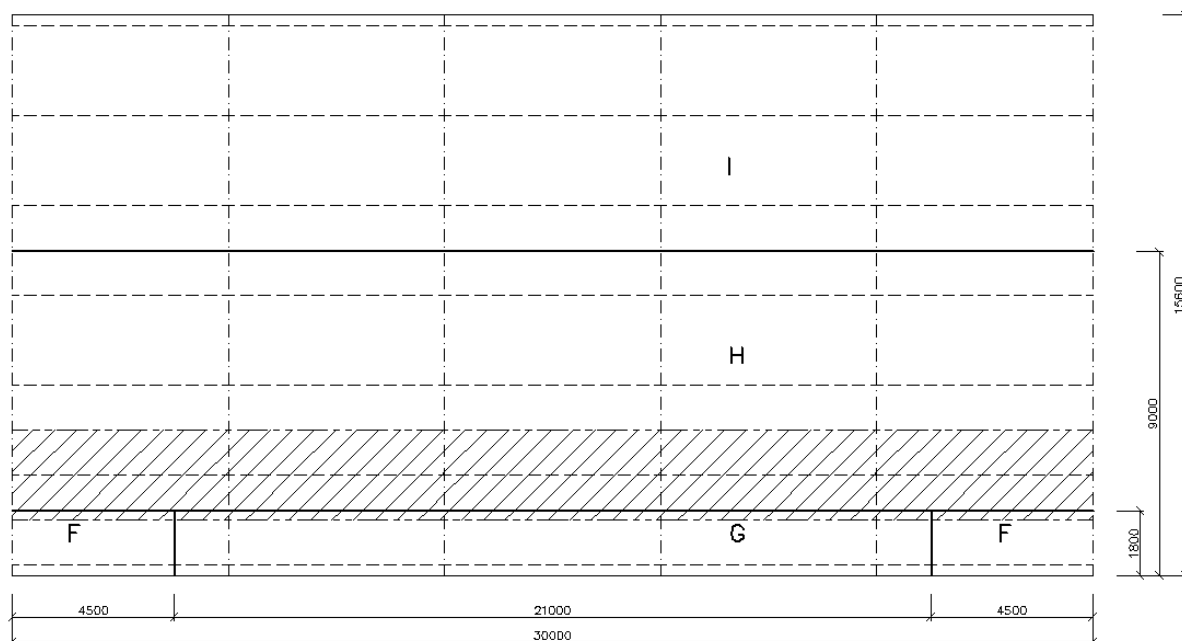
Půdorys střechy, zatížení větrem podélným
